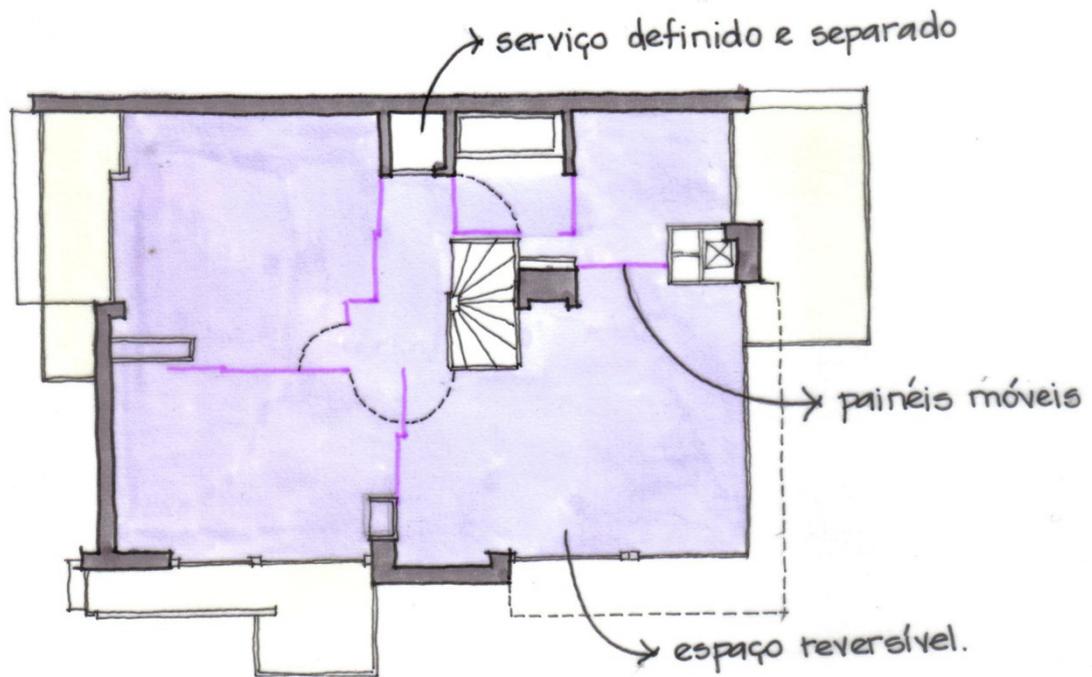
Planta pavimento térreo da Casa Rietveld Schroder.
